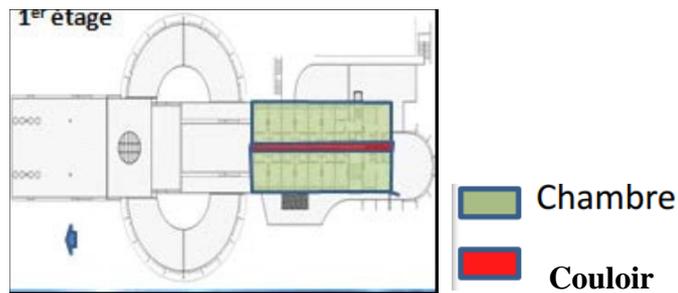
44: Plan 1er étage (google image modifier par l'auteur 2019)
